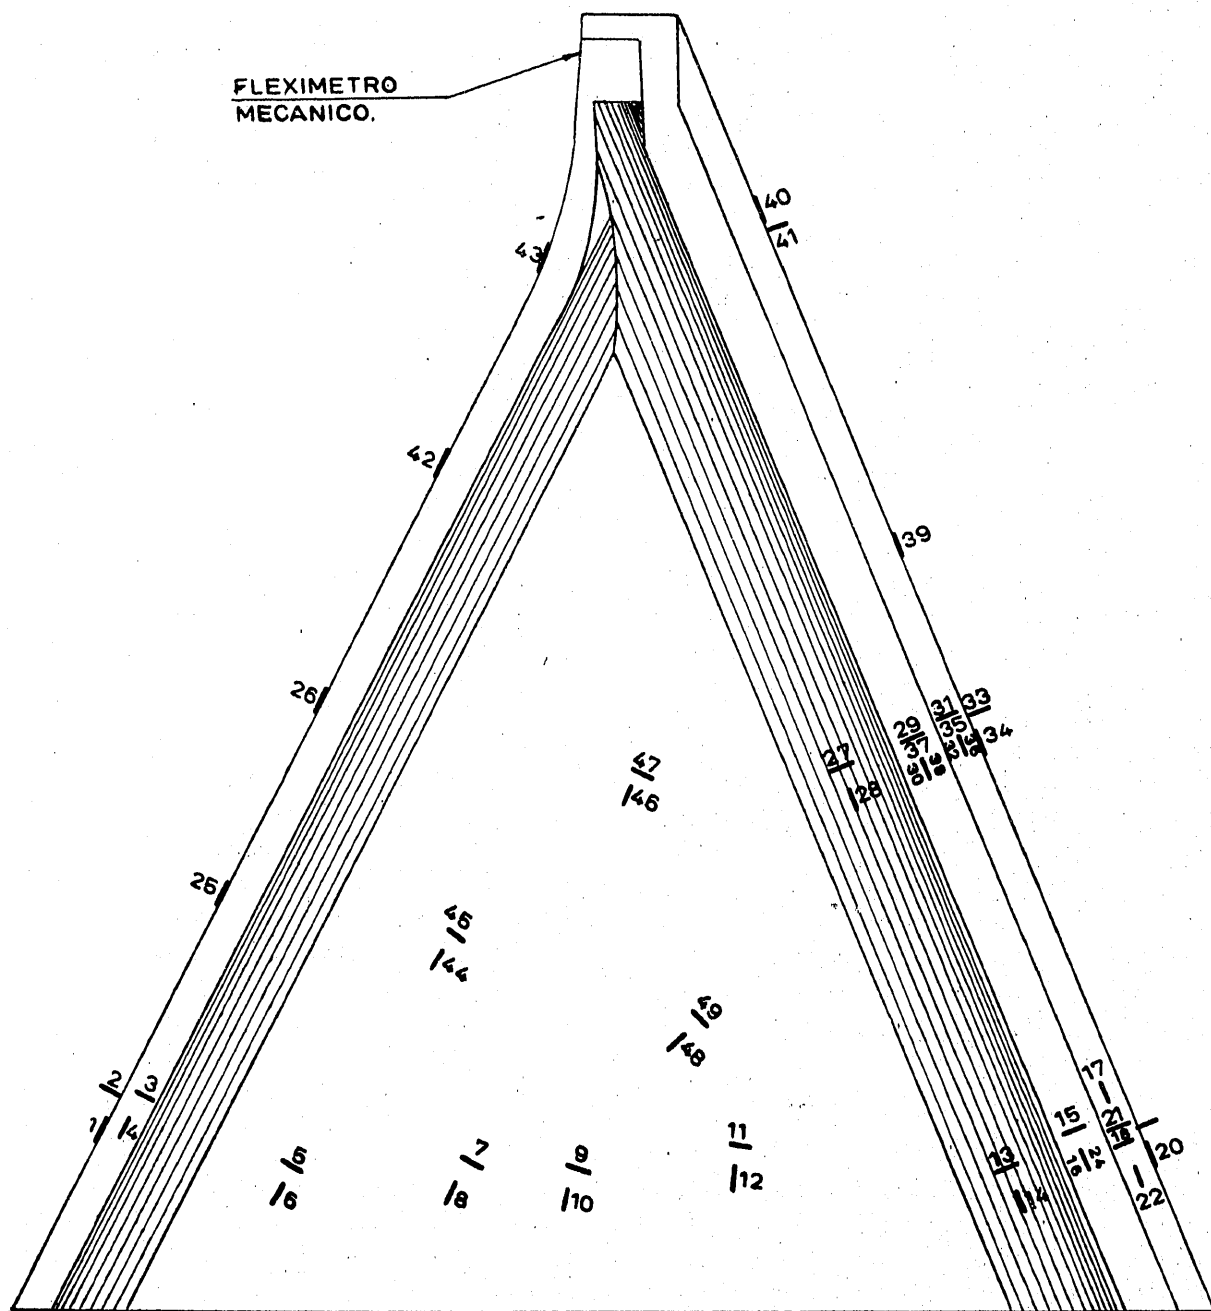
^a — Alzado del modelo de contrafuerte con la disposición de los extensómetros de medida.
